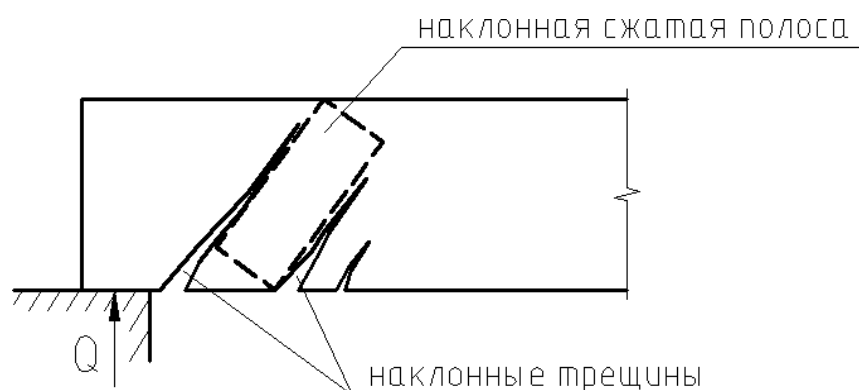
Раздробление бетона наклонной сжатой полосы между наклонными трещинами.
